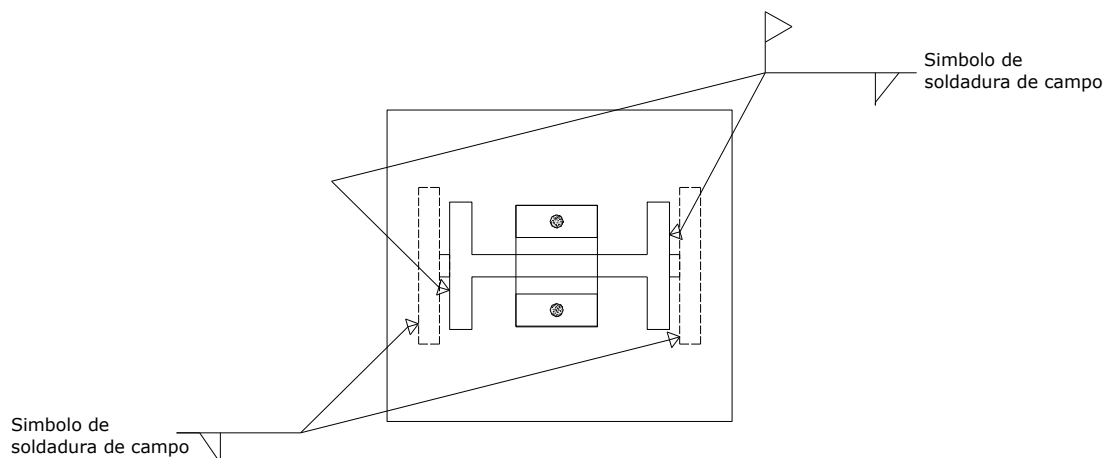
Vista en planta de empalmes de columnas de diferente peralte.
